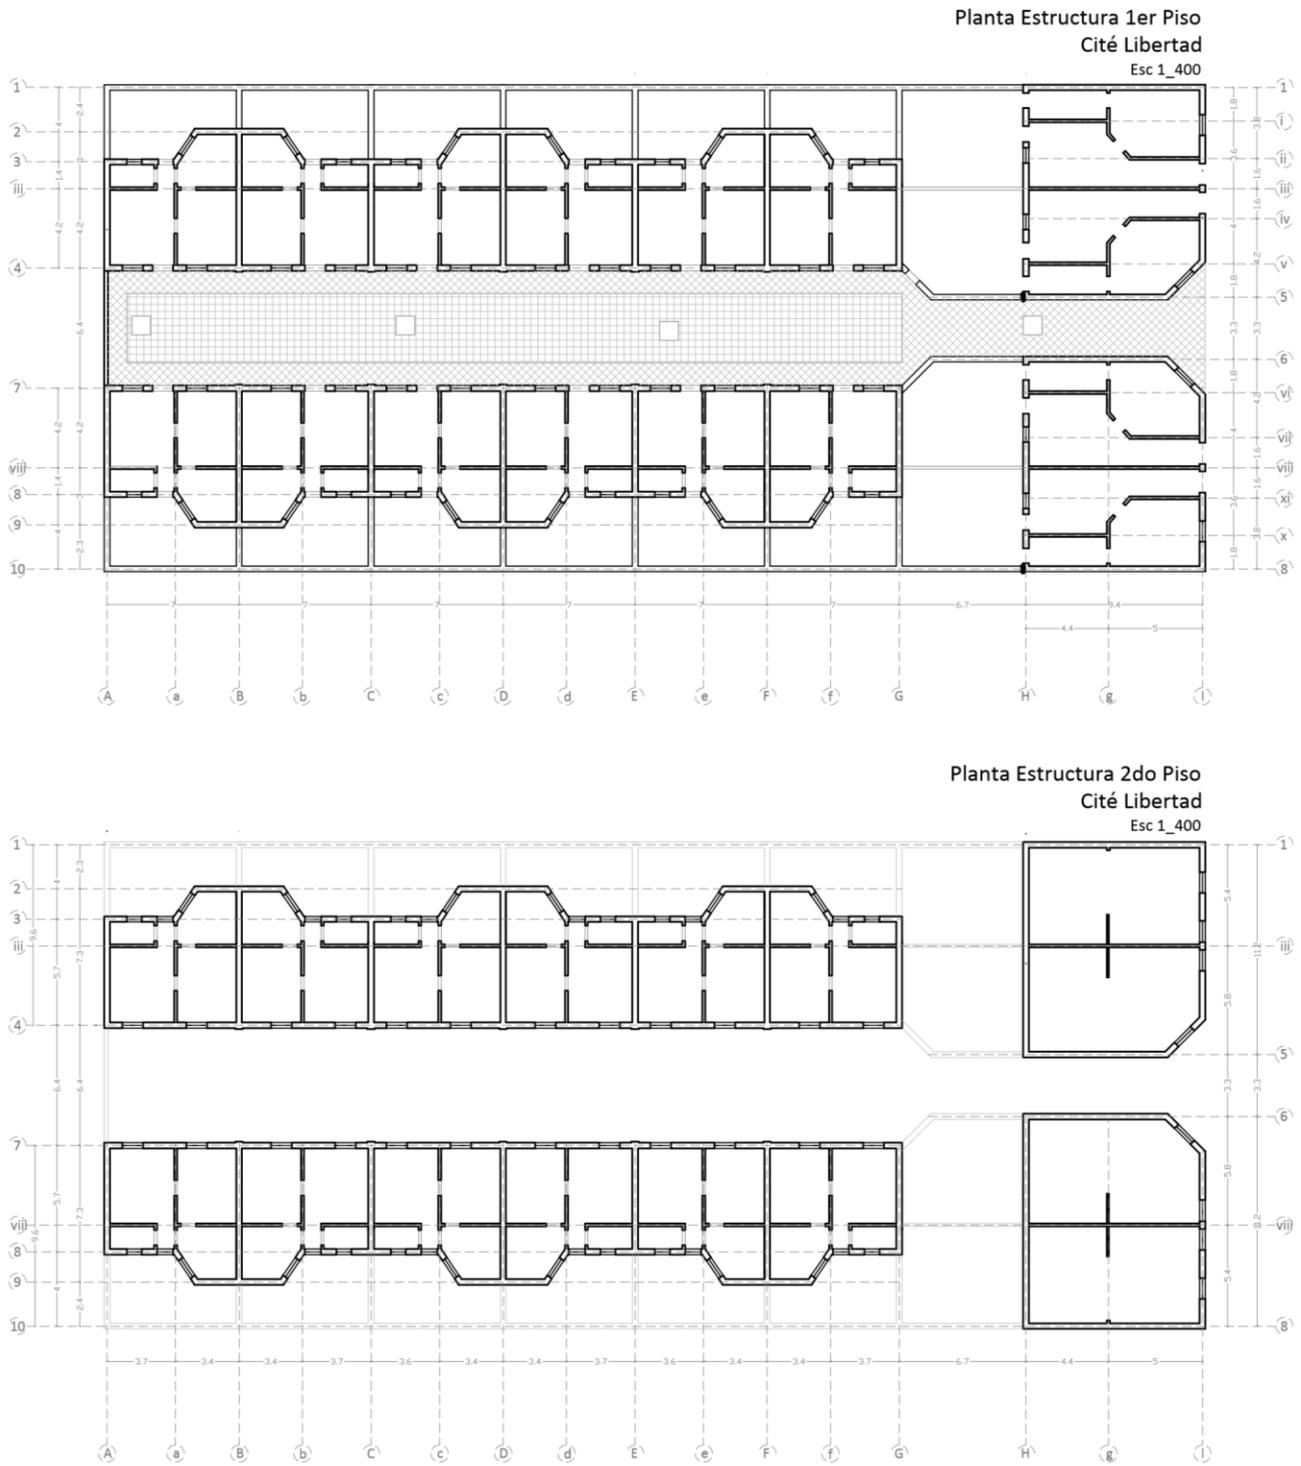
Planta Estructura 1er y 2do piso Cité Libertad.
